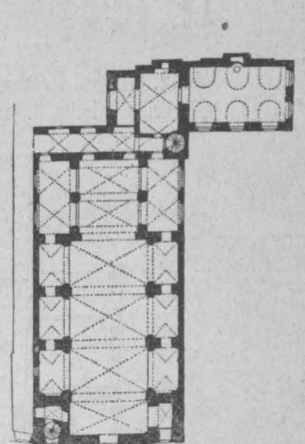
Grundriß der St. Josefkirche, Laimgrube, VI. Bez.
